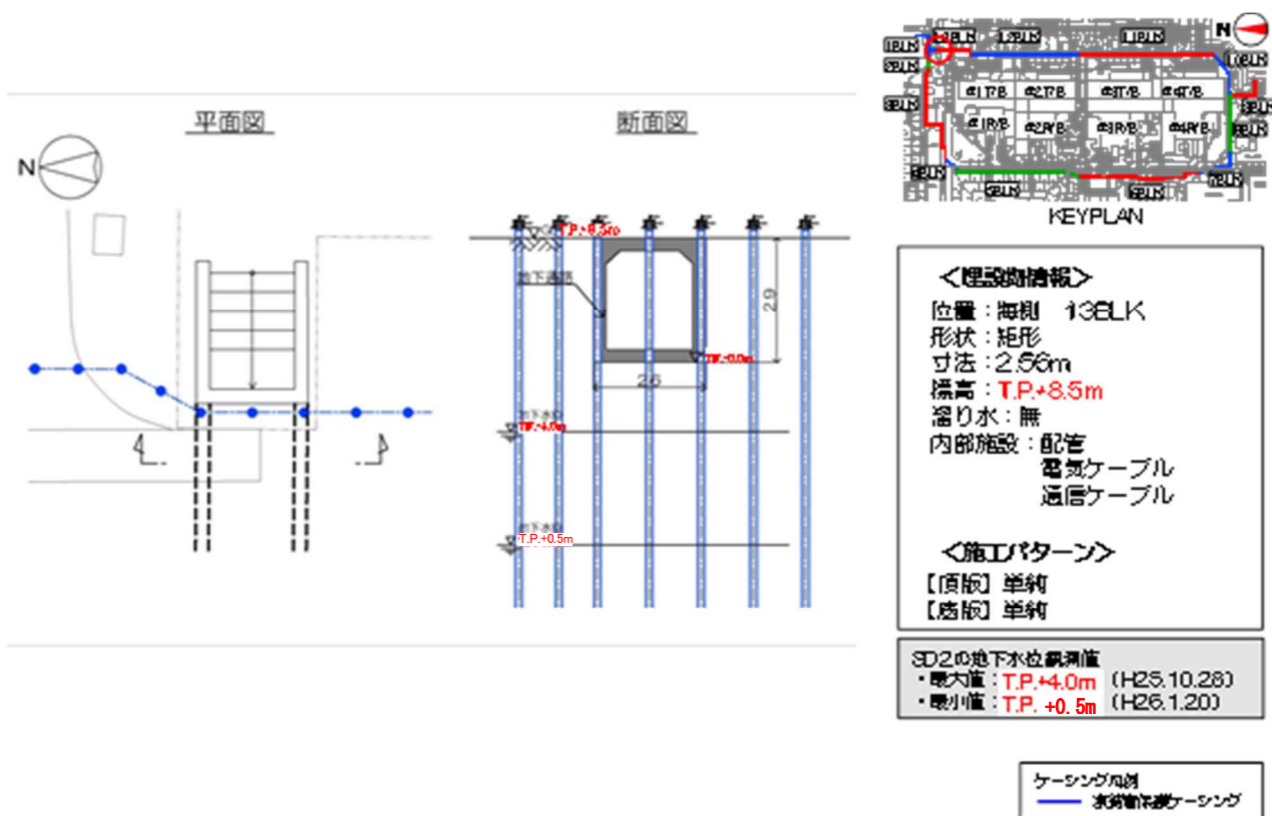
【13-2】地下通路 施工方法 (貫通施工)
